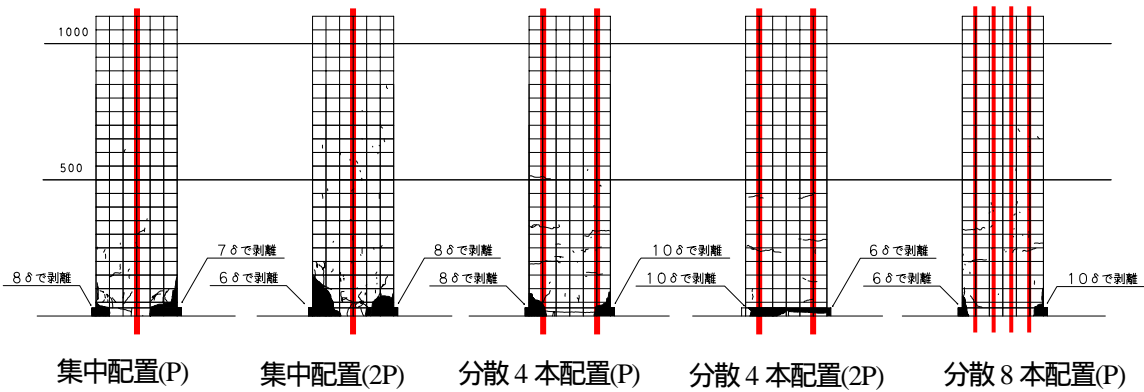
載荷終了時の損傷およびひび割れ状況
